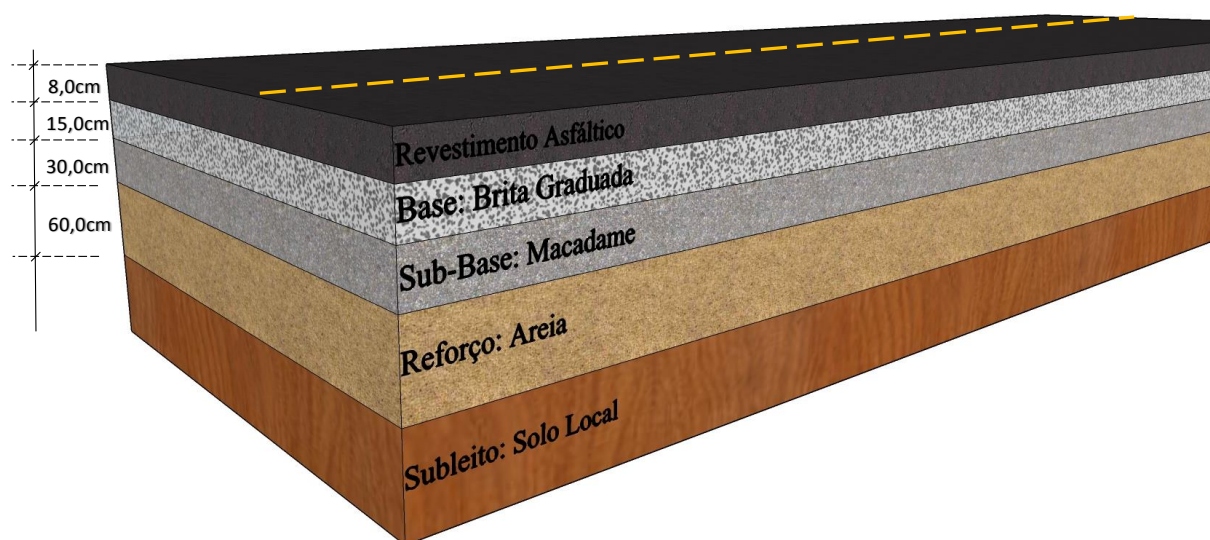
Estrutura típica do pavimento dos trechos experimentais da BR 290/RS
